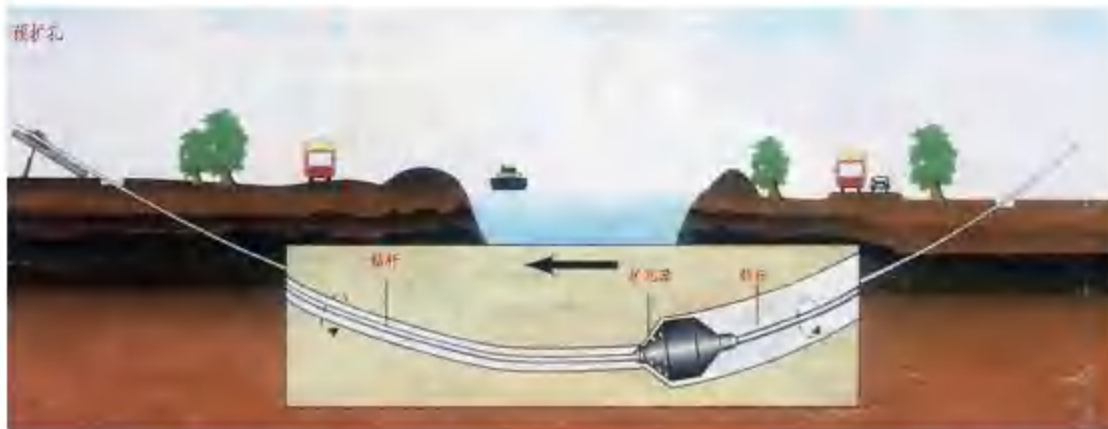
定向钻穿越施工预扩孔过程断面示意图
